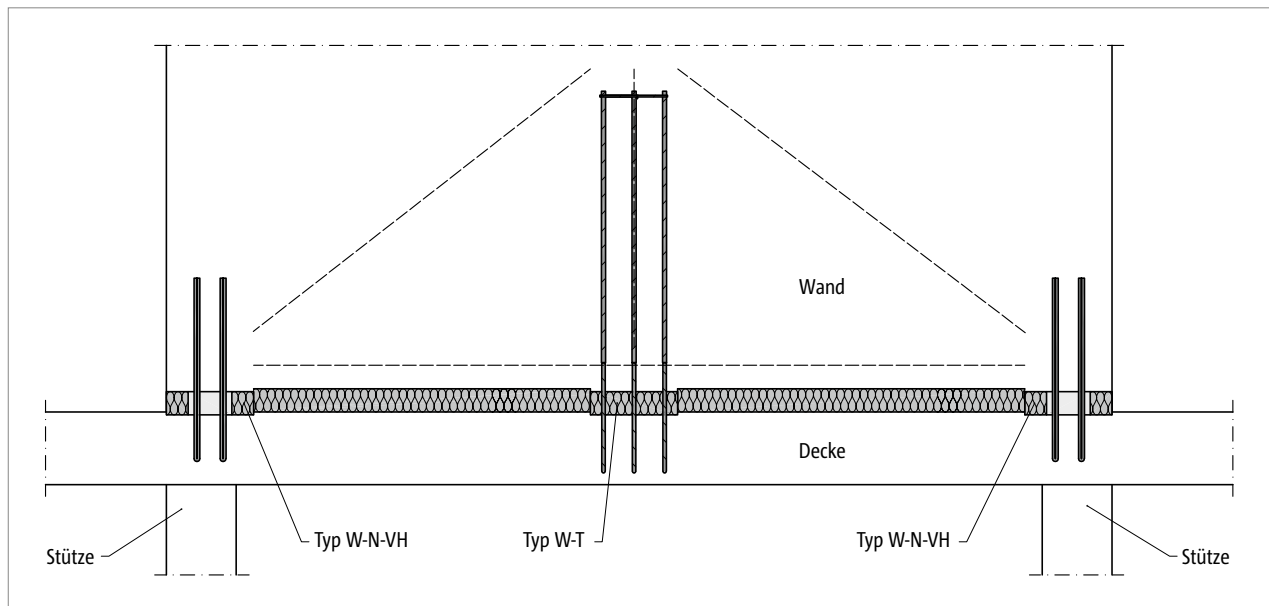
Schöck Sconnex® Typ W: Kombinierte Produktvarianten für den Anschluss eines wandartigen Trägers mit Deckenaufhängung
